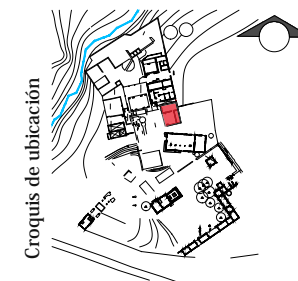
Planos del levantamiento arquitectónico del estado actual.
